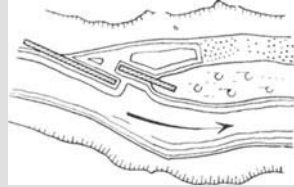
Abschließung eines Nebenarmes zur allmählichen Verlandung mit Leitwerken.
